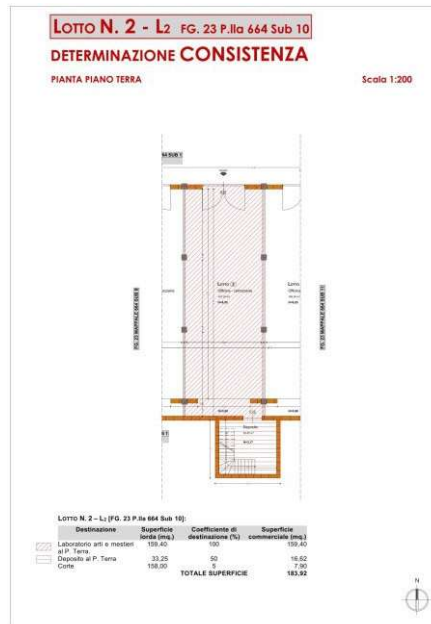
Determinazione consistenza Lotto L₂ (ALL. 11).
